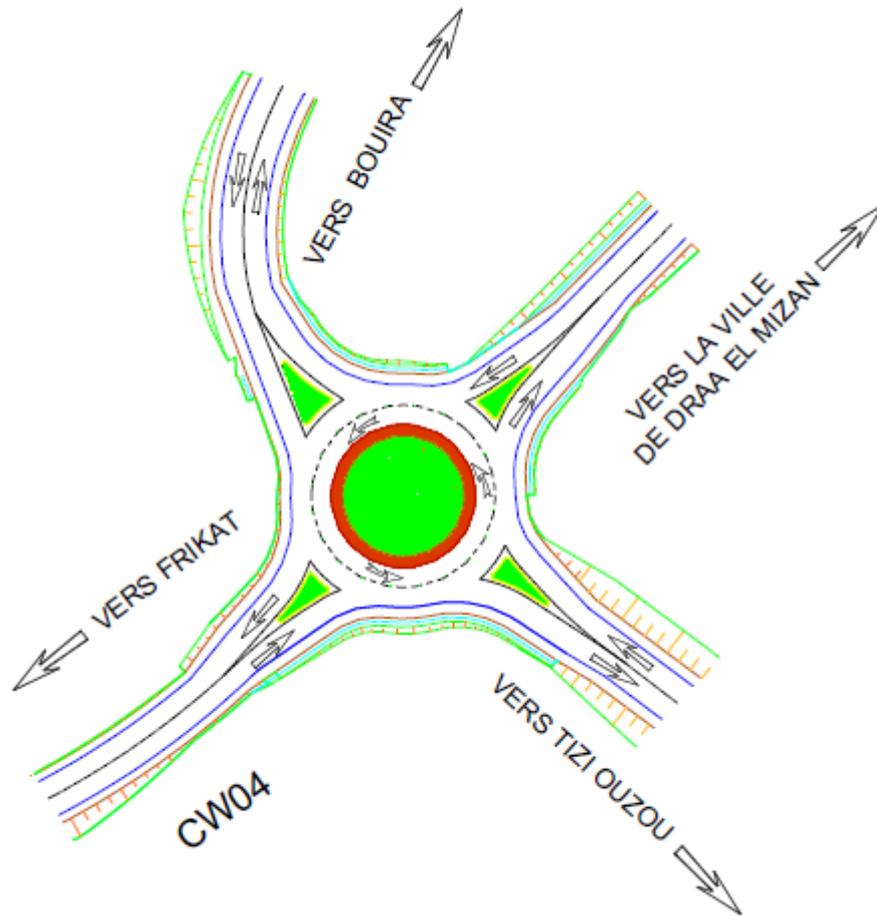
Plan du carrefour giratoire au PK1+600 :
